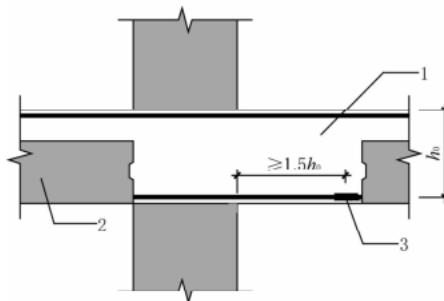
梁纵向钢筋在节点区外的后浇段内连接示意
